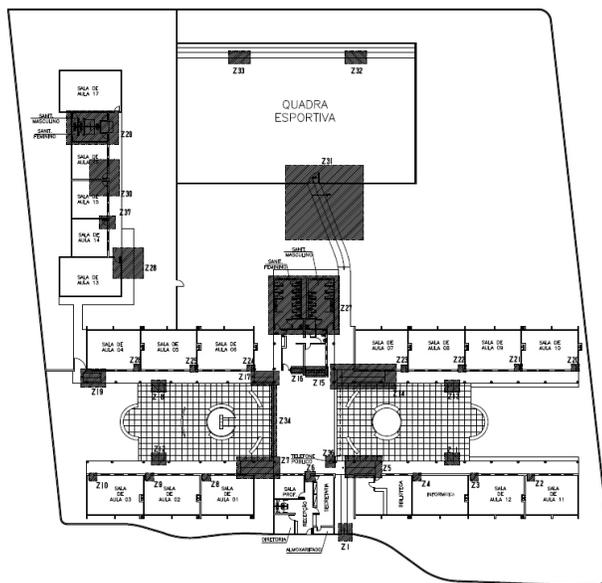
Planta geral da Escola Isabel Ferreira – visualização esquemática para fins ilustrativos das zonas onde foram realizadas intervenções do projeto de acessibilidade.
